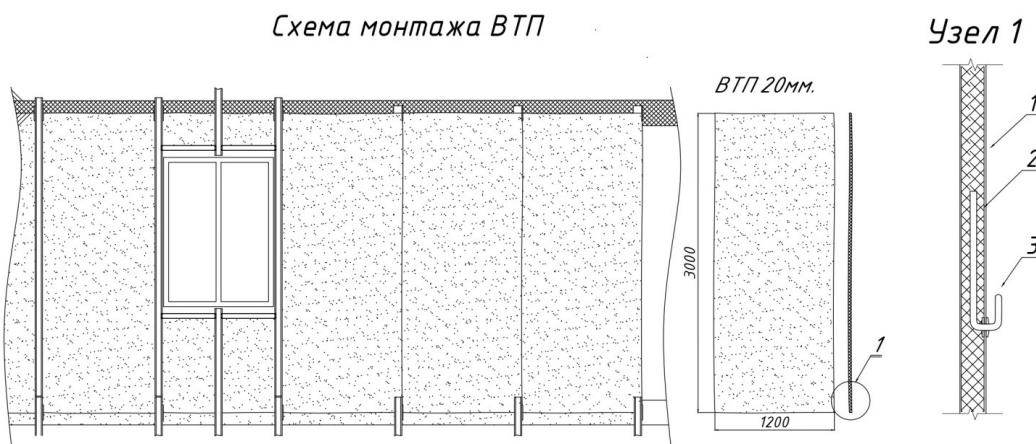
Схема монтажа вакуумированных теплоизоляционных панелей (ВТП) к фасаду здания: 1 – вакуумированная теплоизоляционная панель; 2 – ковелос (аморфный кремнезем); 3 – штенгель.
